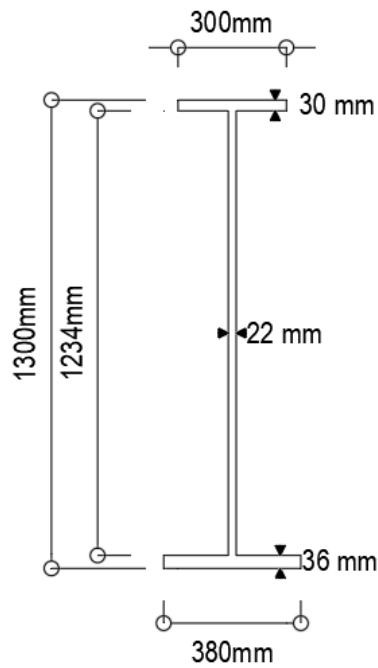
Corte transversal final de la viga exterior variante vigas de acero.
